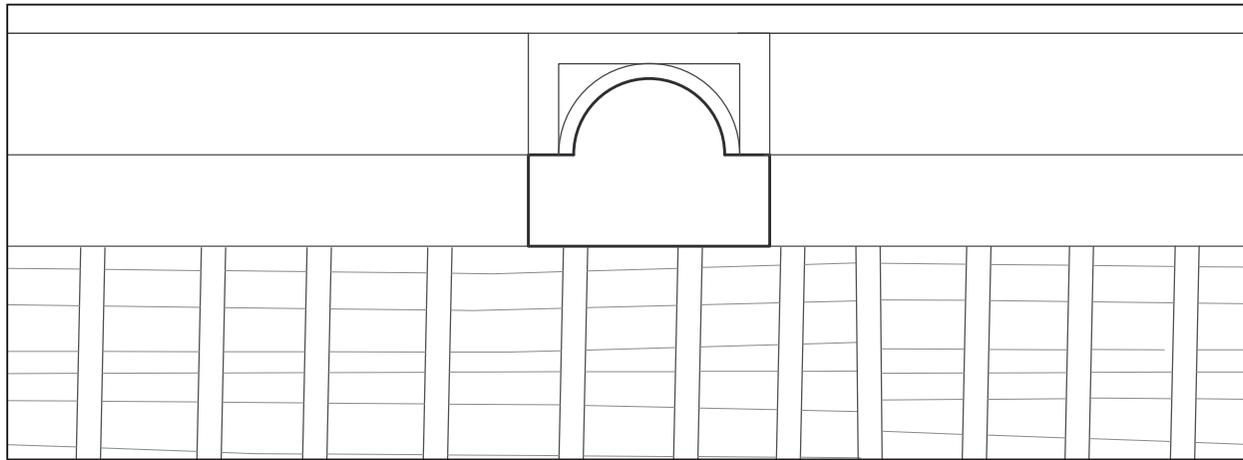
Hipótesis del trazado de techos de planta segunda de la Casa de los Miradores, detalle de armadura mudéjar. (Ibídem)
